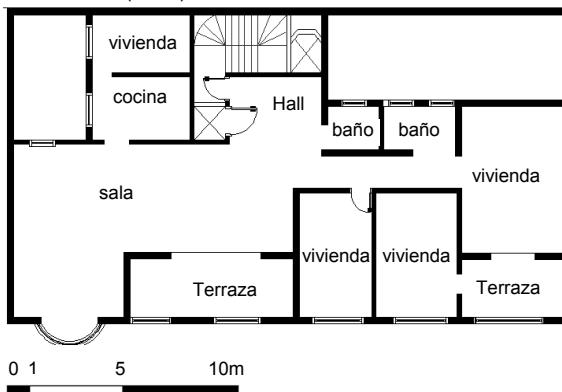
Planta reconfigurada de la planta baja del Edificio María Paula (2001)
